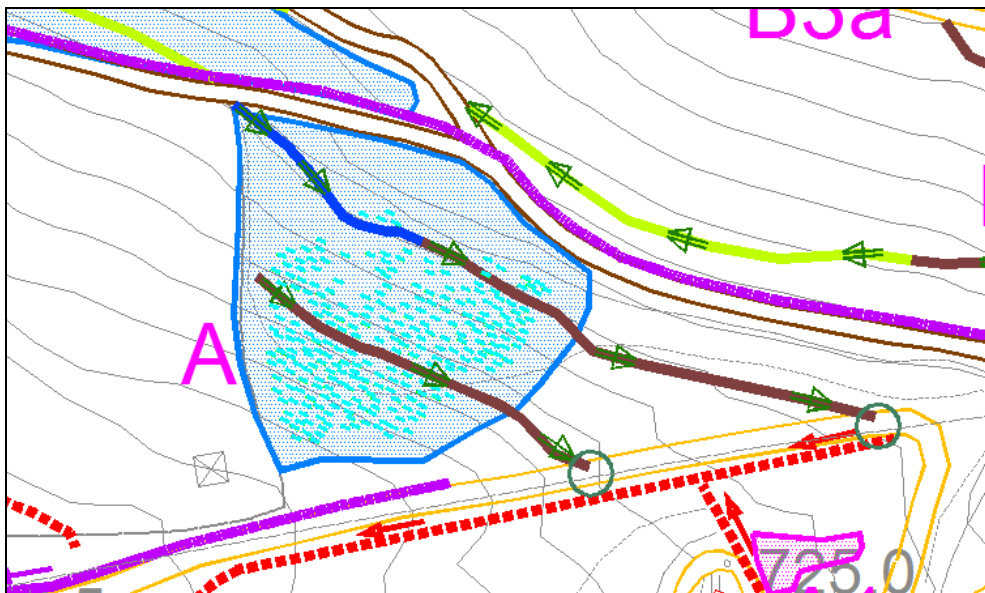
Unità progettuale A (cfr. elaborato C2 - Planimetria generale di progetto)
